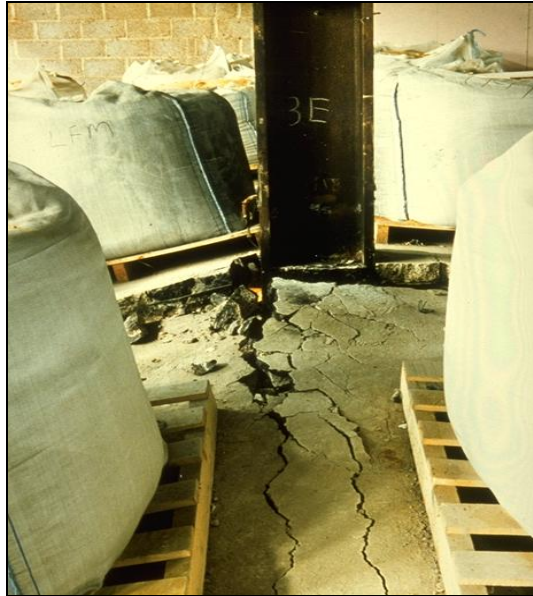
Laje de piso fissurada numa zona em que as armaduras não estavam corretamente amarradas (Vassart & Zhao, 2012).
